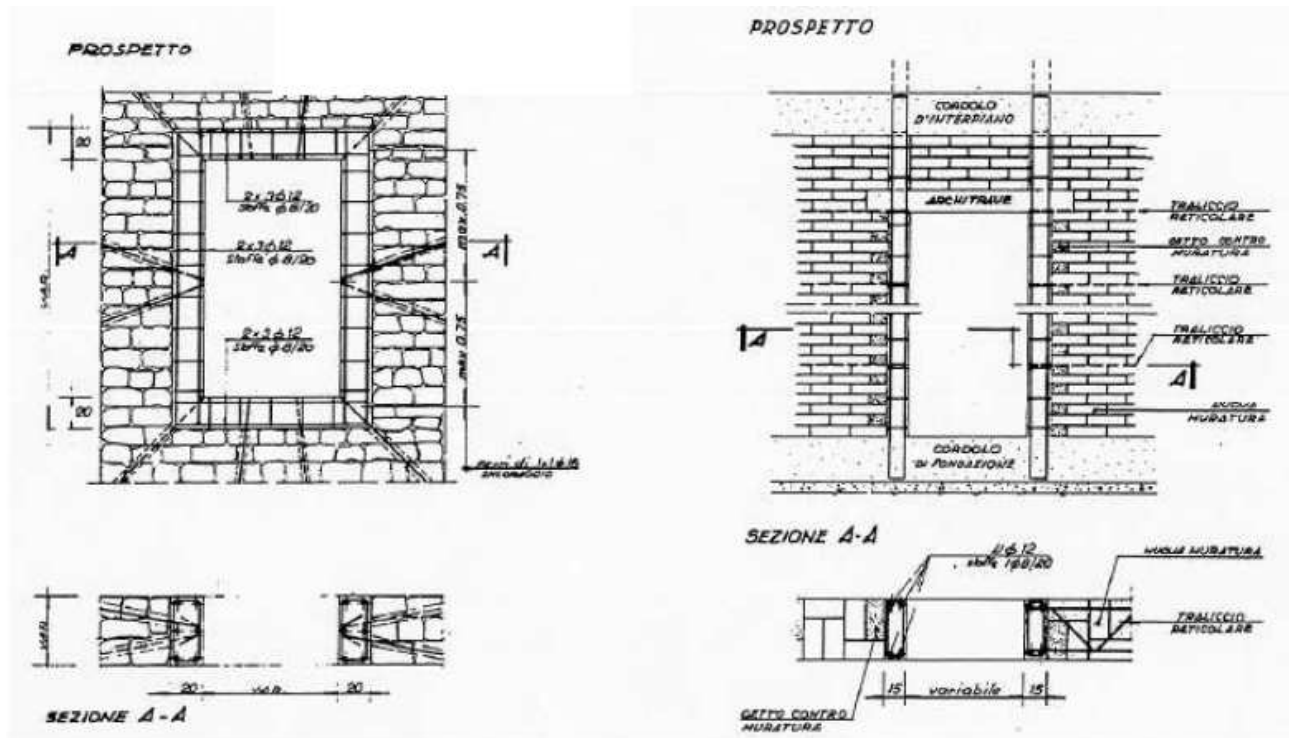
Cerchiatura di aperture (finestre, porte) mediante intelaiature in c.a.
